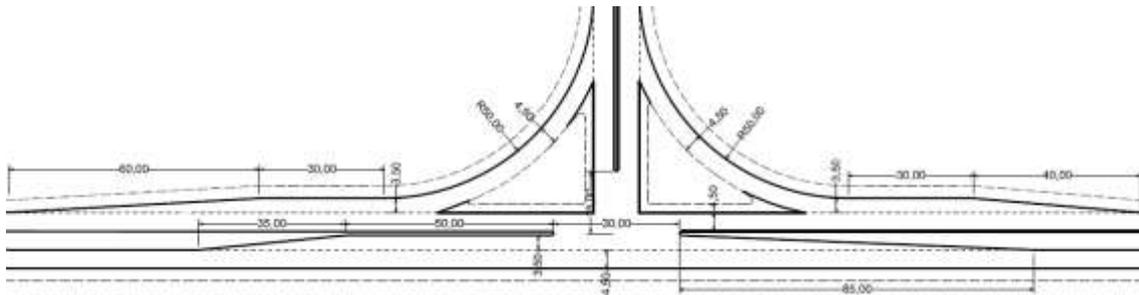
Planimetría de intersección canalizada recta tipo adoptada
